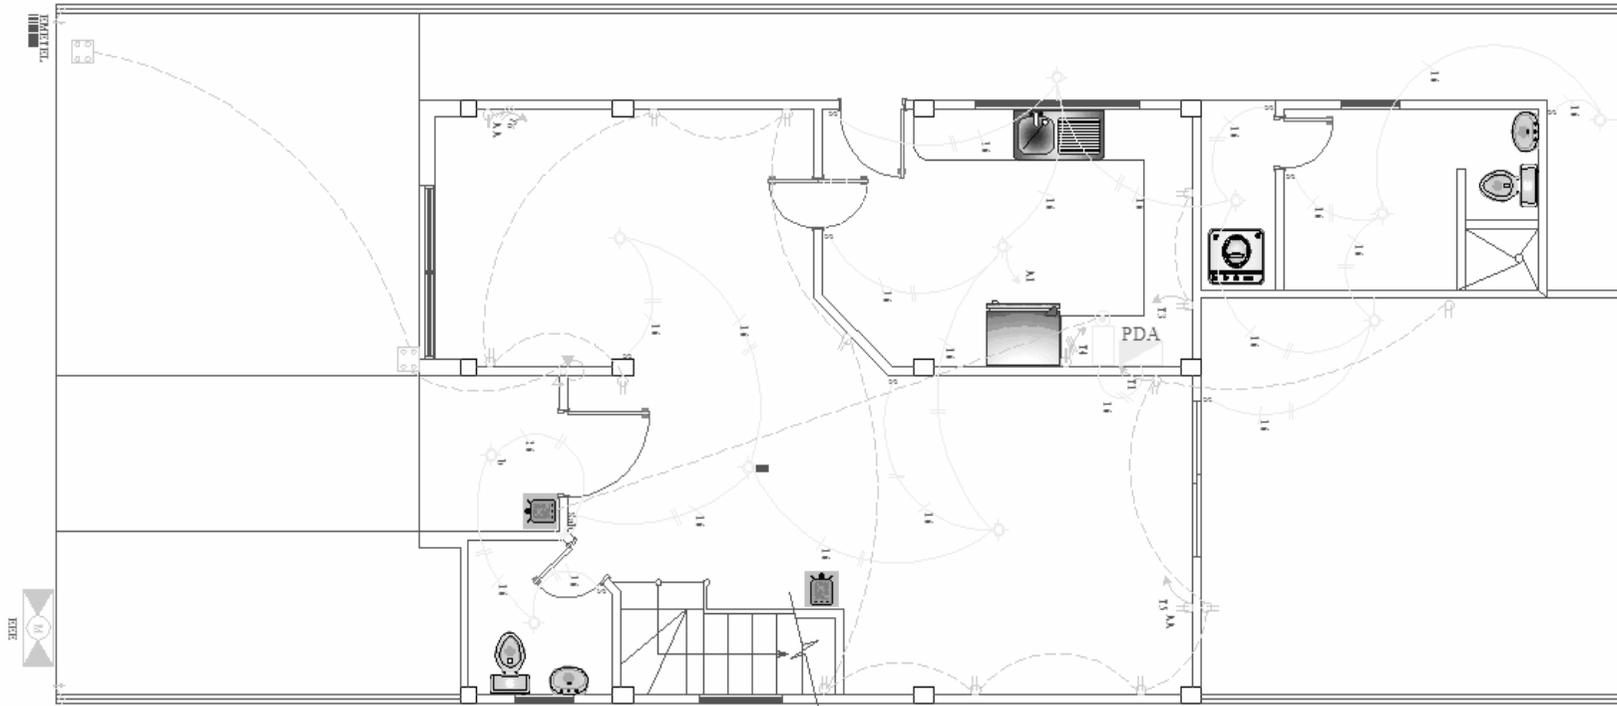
Sistema de Acceso Remoto, Planta Baja, Plano Eléctrico.
